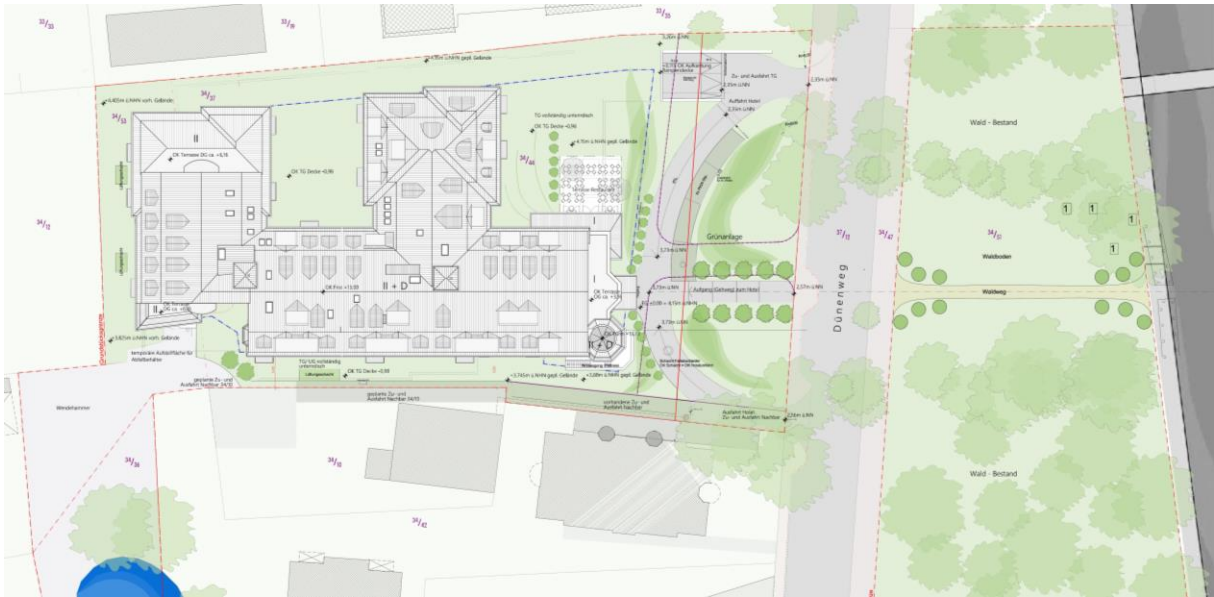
Lageplan. Allgemeiner Freiflächenplan. Baltischer Hof, Suitenhotel in Boltenhagen. Architekt: Planungsgruppe Gieseke, Kühlungsborn und Pohl Architektur, Berlin. Stand Februar 2018
